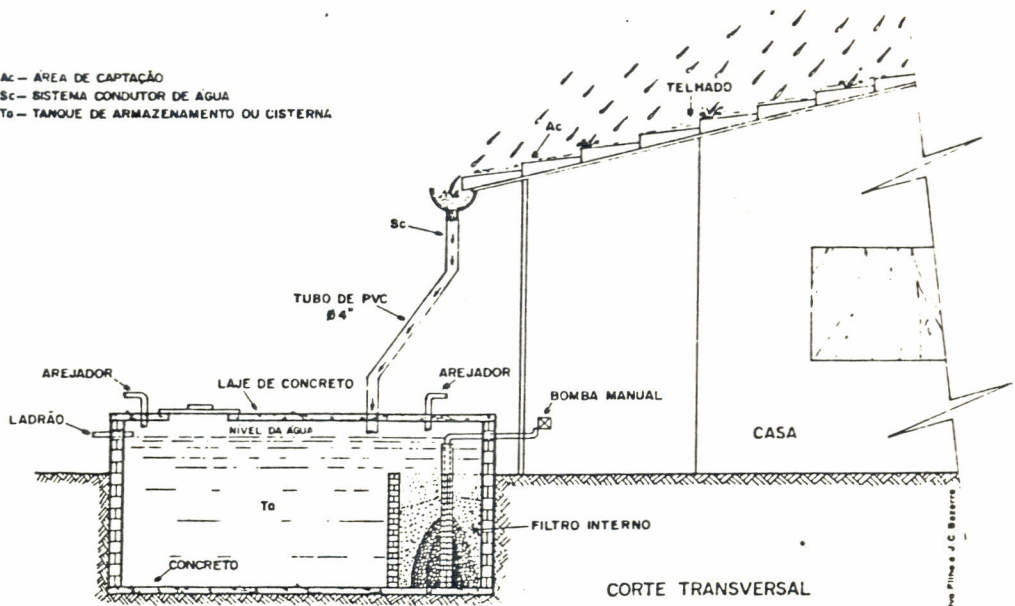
Modelo esquemático de uma cisterna de alvenaria com área de captação no telhado.
